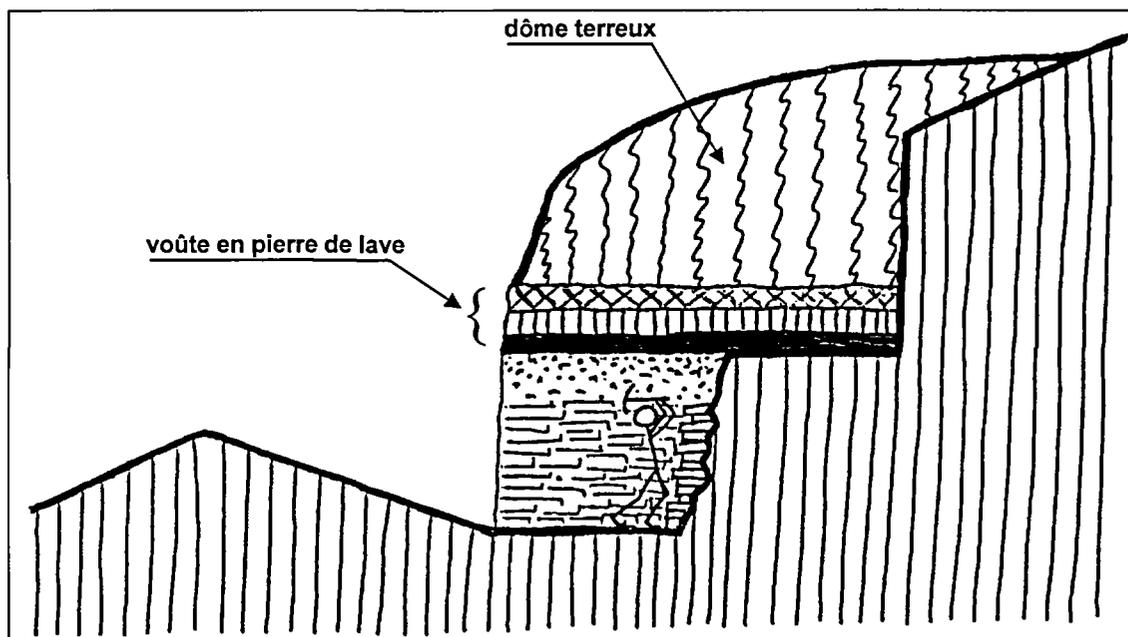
Creusement de la galerie à l'abri du coffrage mis en place sur la forme A (ill. 6)
